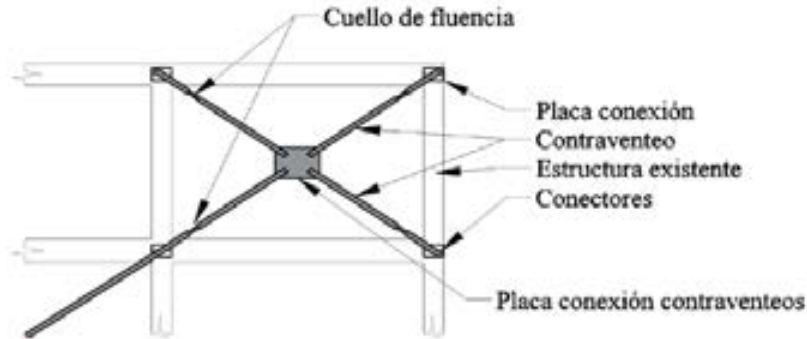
Contraventeo externo al plano del muro de concreto
